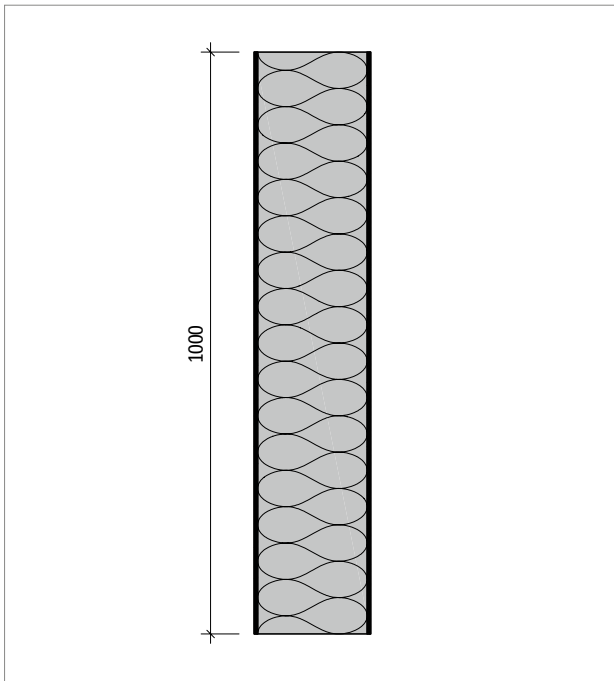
Schöck Isokorb® CXT Typ A Part Z: Produktdraufsicht
